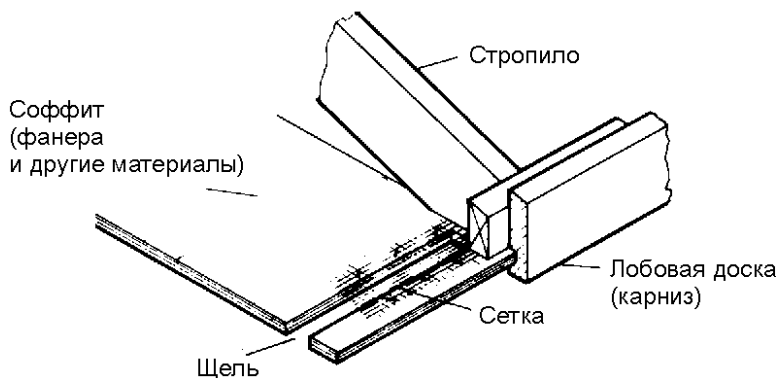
Узкая щель может быть использована для создания вентиляции вместо устройства вентиляции в карнизе (Forest Products Laboratory)
